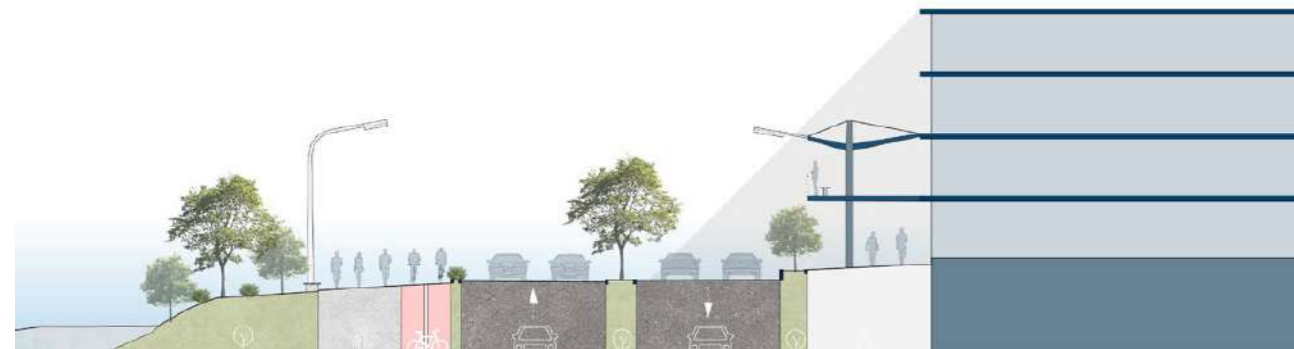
Sección vial (Tramo 10-15m). Fuente: Autoría propia (2026)
